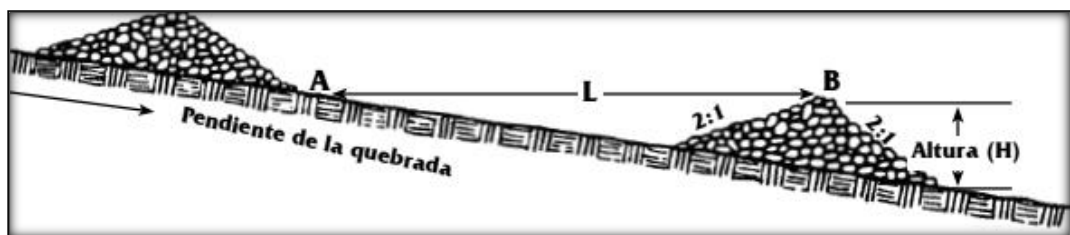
Detalles de separación entre estructuras de control quebradas.
